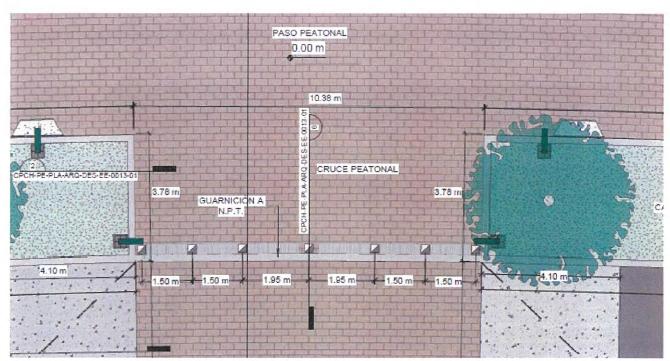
Detalle en planta de despiece de piezas prefabricadas de concreto en desembarco en Estacionamiento Ecológico.
